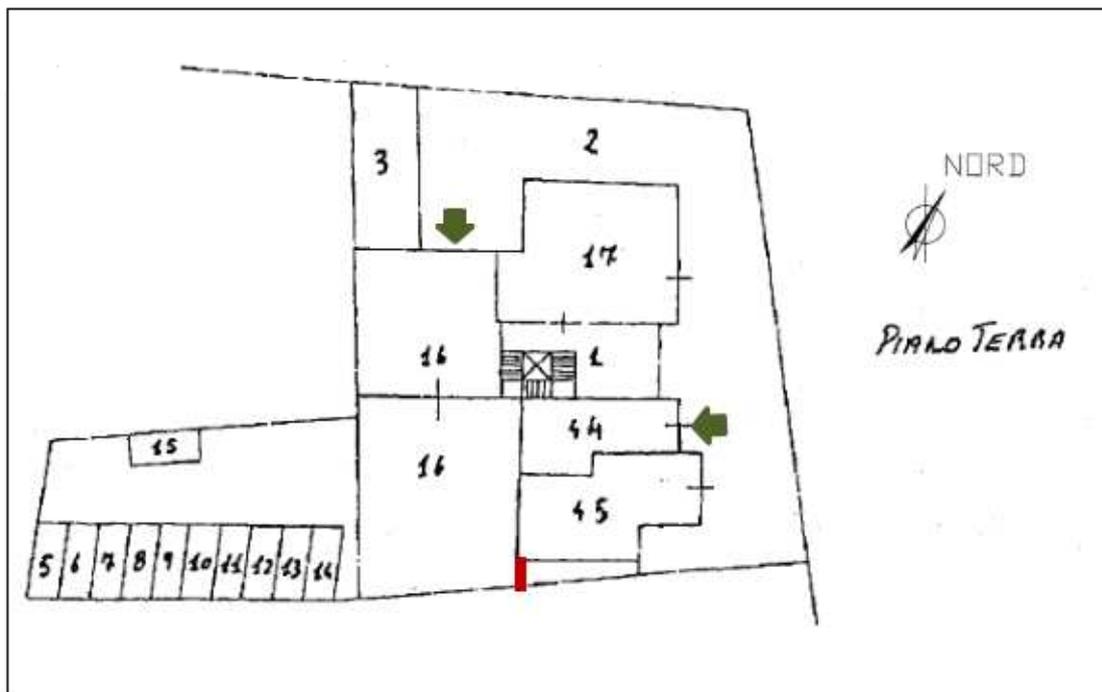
Elaborato planimetrico. Individuazione ingressi. Sub 16 - Corte interna. Muro di cinta esclude una porzione di proprietà
